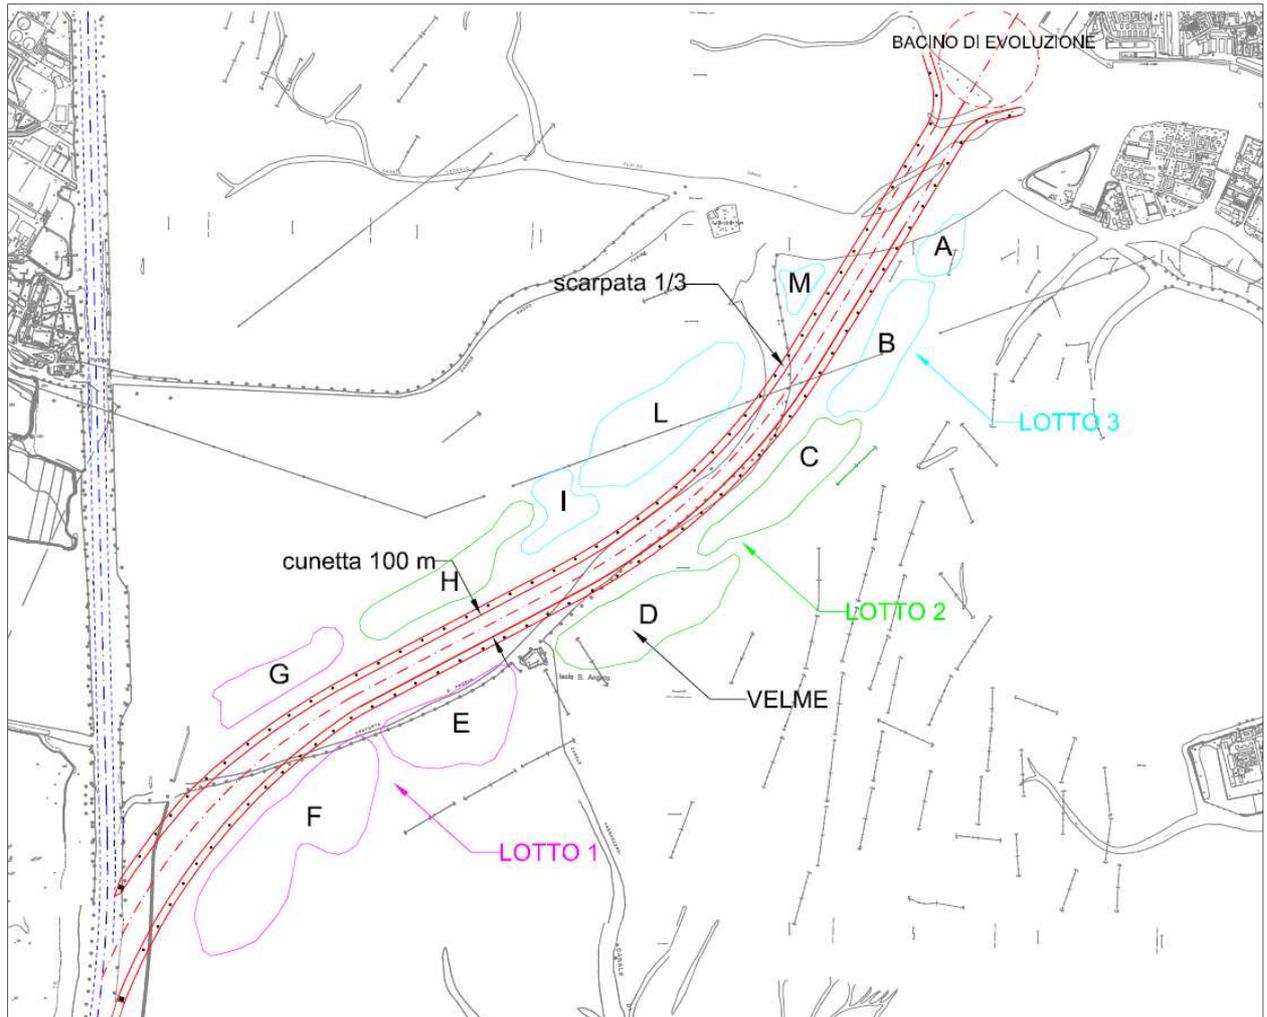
Andamento planimetrico del canale, denominazione e disposizione delle velme in progetto
